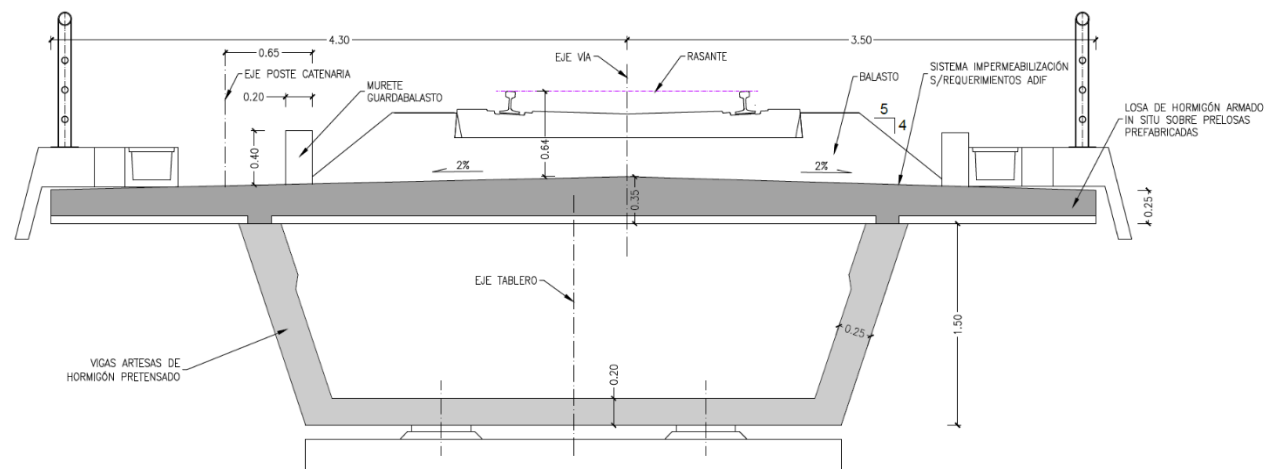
Alzado. Viaducto sobre el canal Imperial de Aragón.
